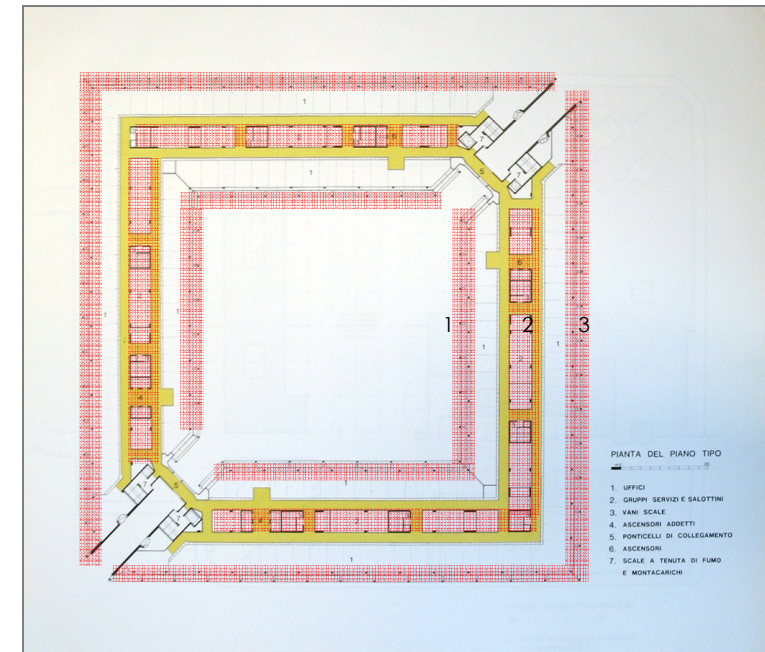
pianta del piano tipo – individuazione schema strutturale
